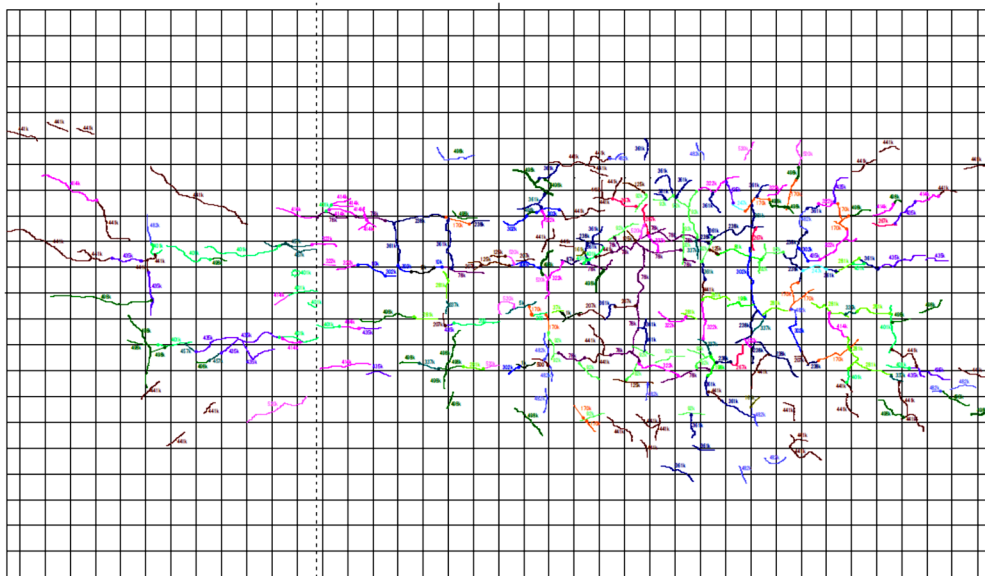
ひび割れ観察図（下面）
